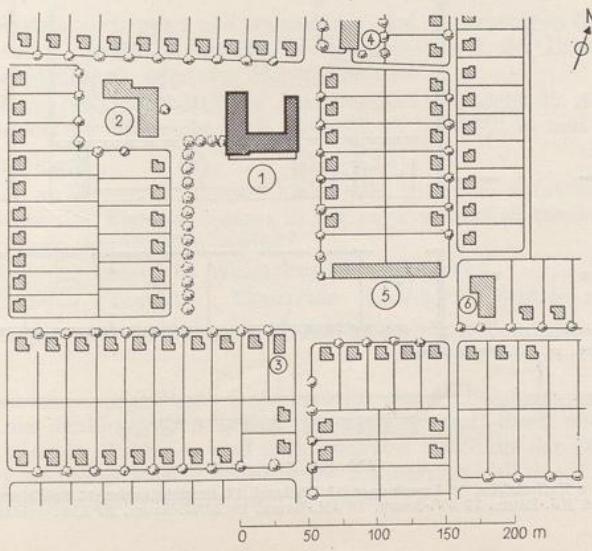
Feierabendhaus in Labiau, Lageplan.
